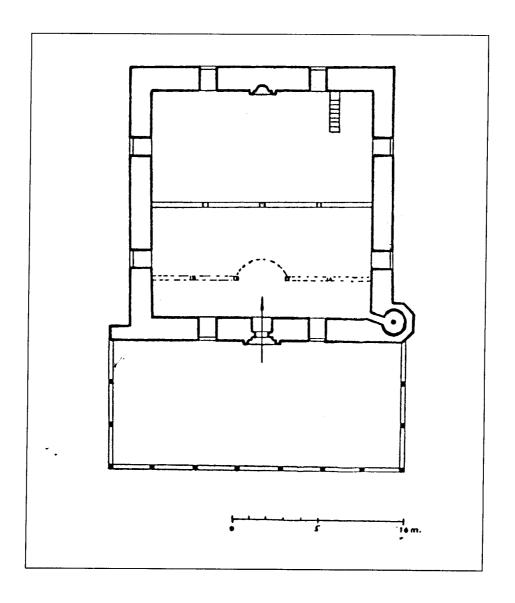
مسقط أفقي لمسجد سوكللو محمد باشا المعروف بمسجد باب العزب (عزب قابي) بإستانبول (عن : كوران)
